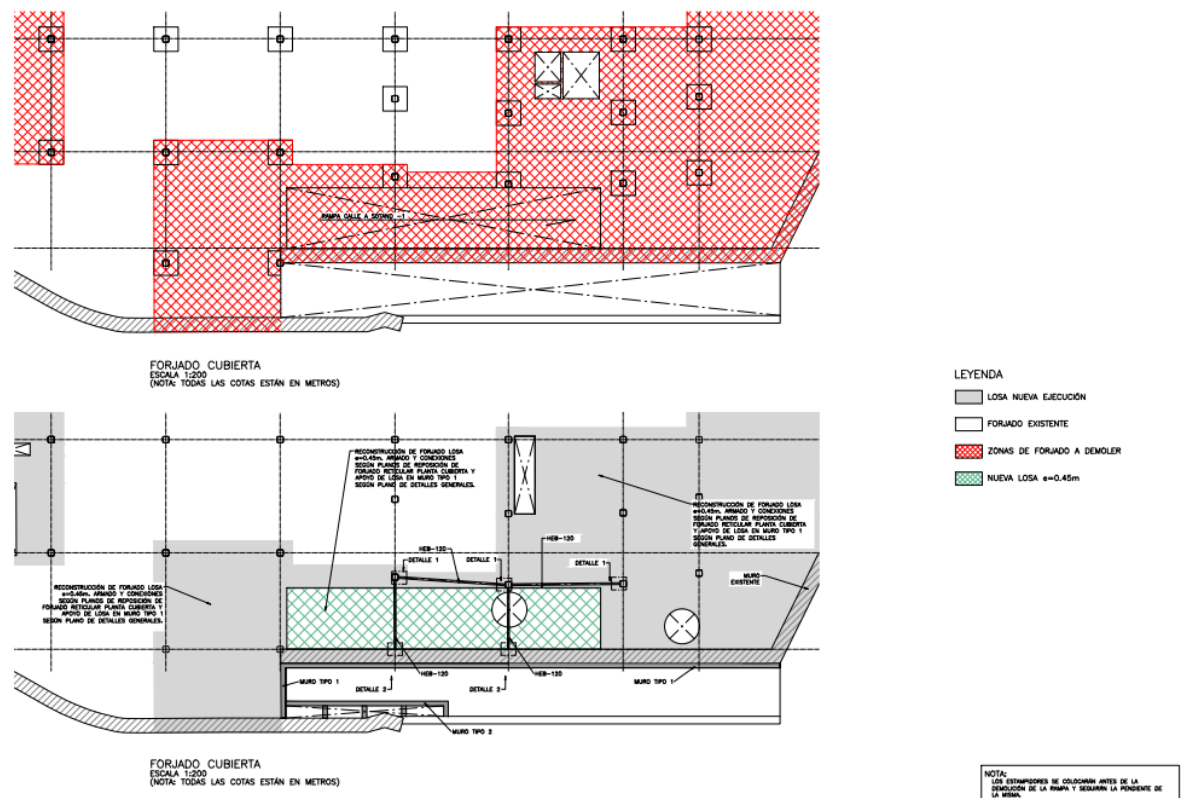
Planta estructura de actuación en zona de acceso y rampa calle Doctor Cortezo.
